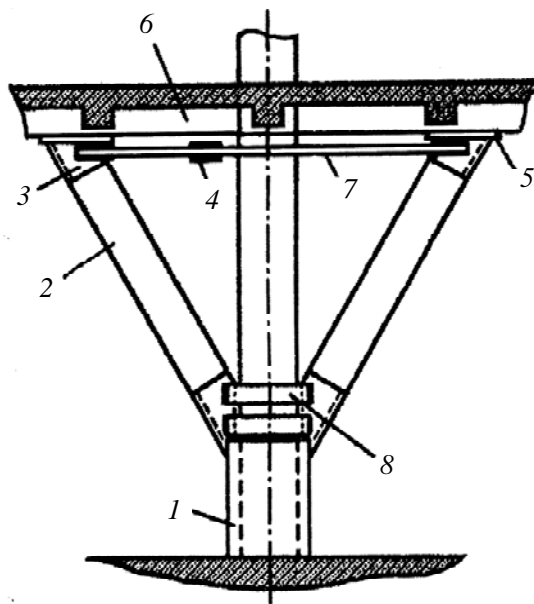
Усиление с частичным разгрузением конструкции (дополнительной жесткой опорой – сборные железобетонные подкосы):
